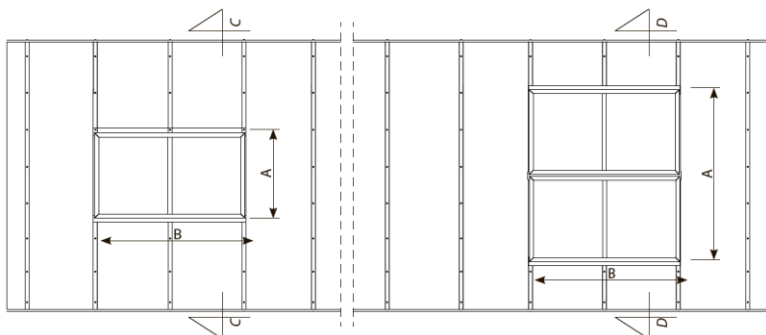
Поперечные сечения стандартной конструкции арочной световой полосы со встроенными люками
